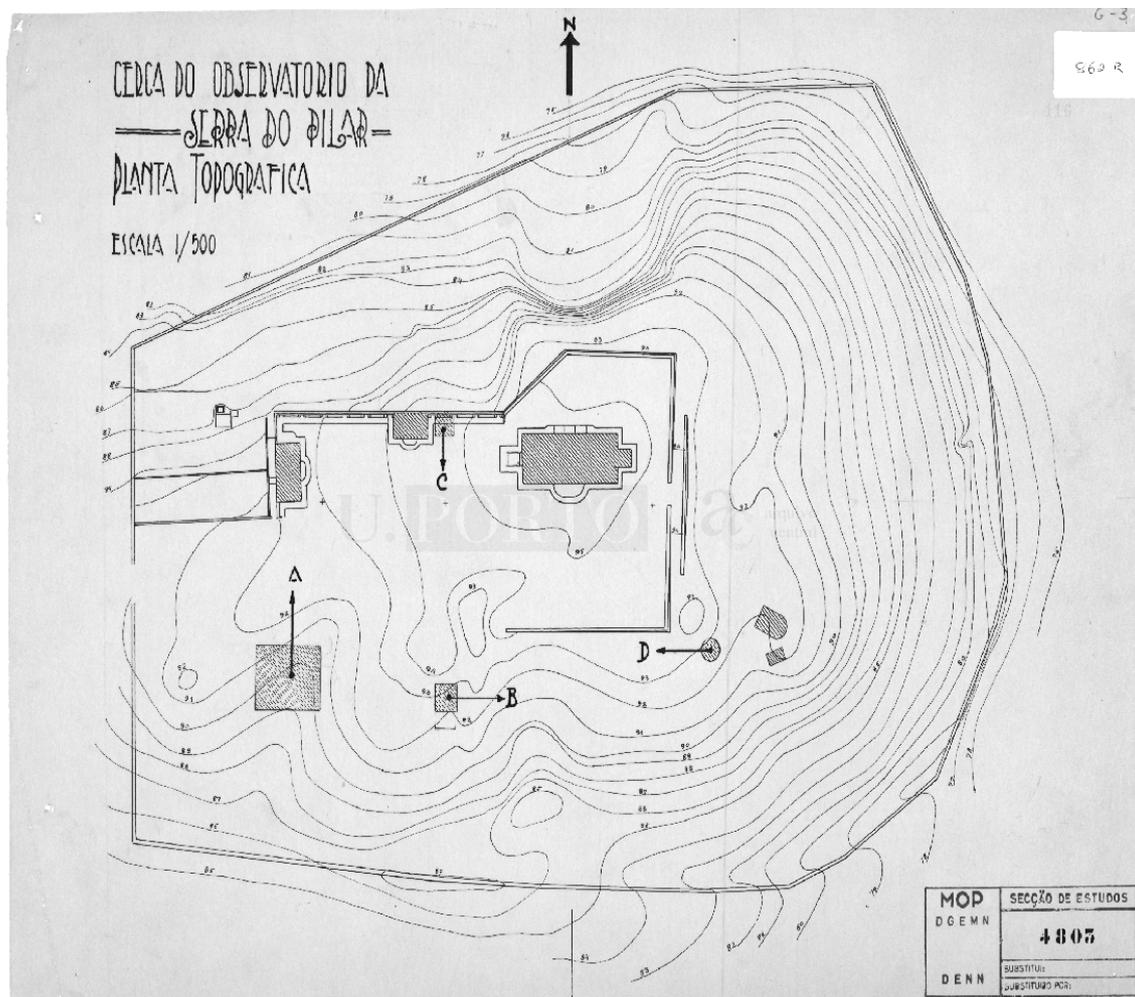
Planta topográfica com cerca e implantação dos edifícios (Planta da DGEMN (s/d). Repositório Temático da Universidade do Porto, 2008).
